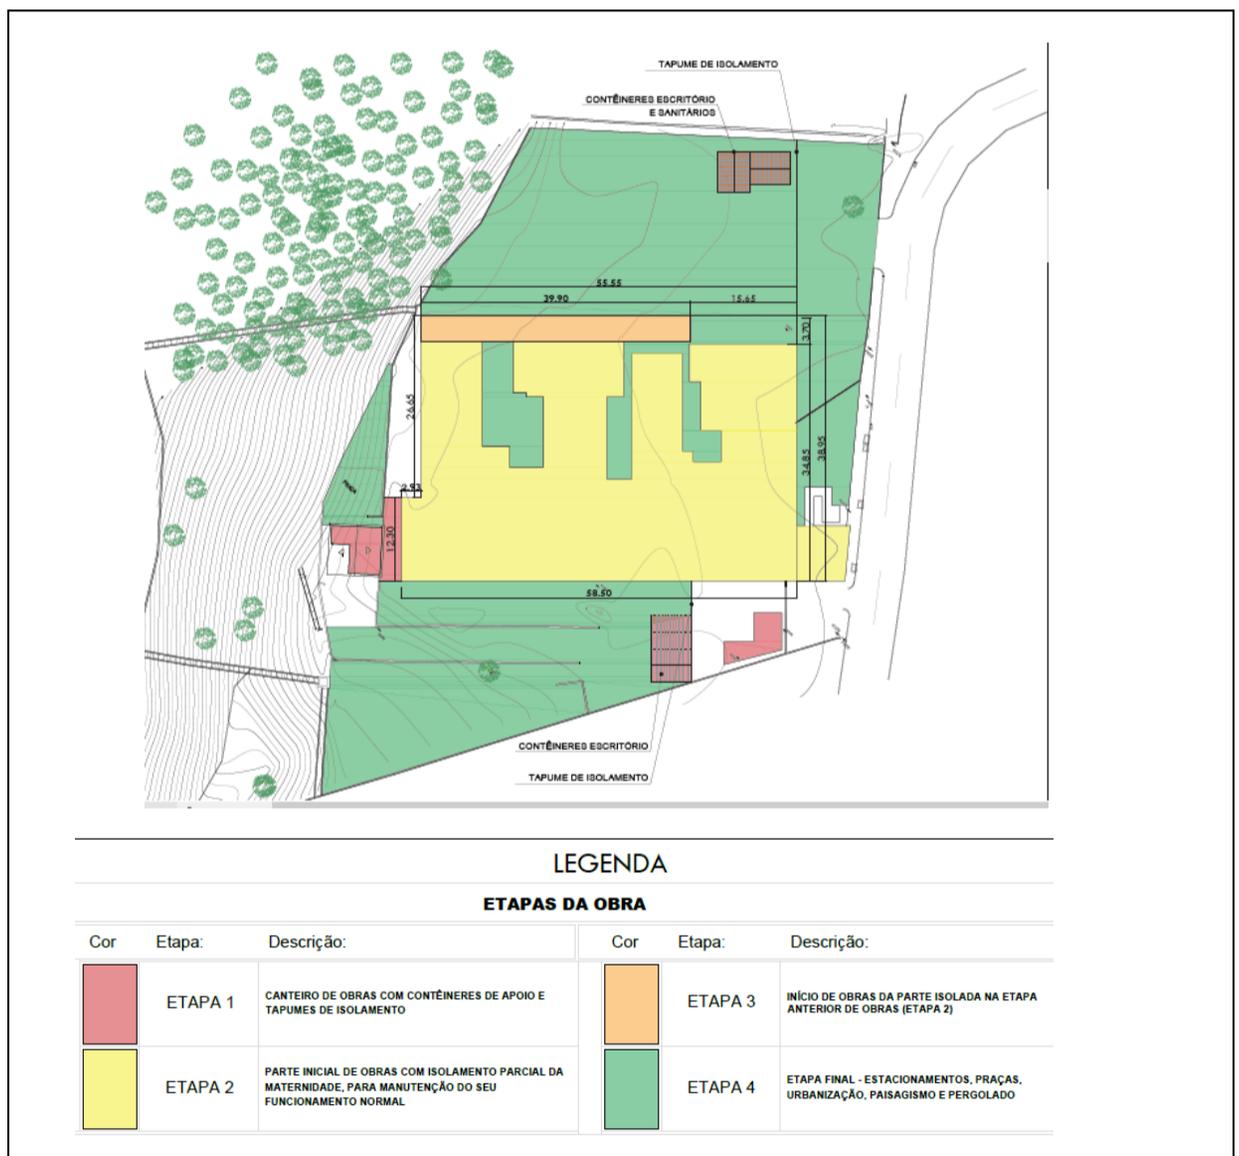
Planta de Canteiro de obras de acordo com o andamento da reforma
